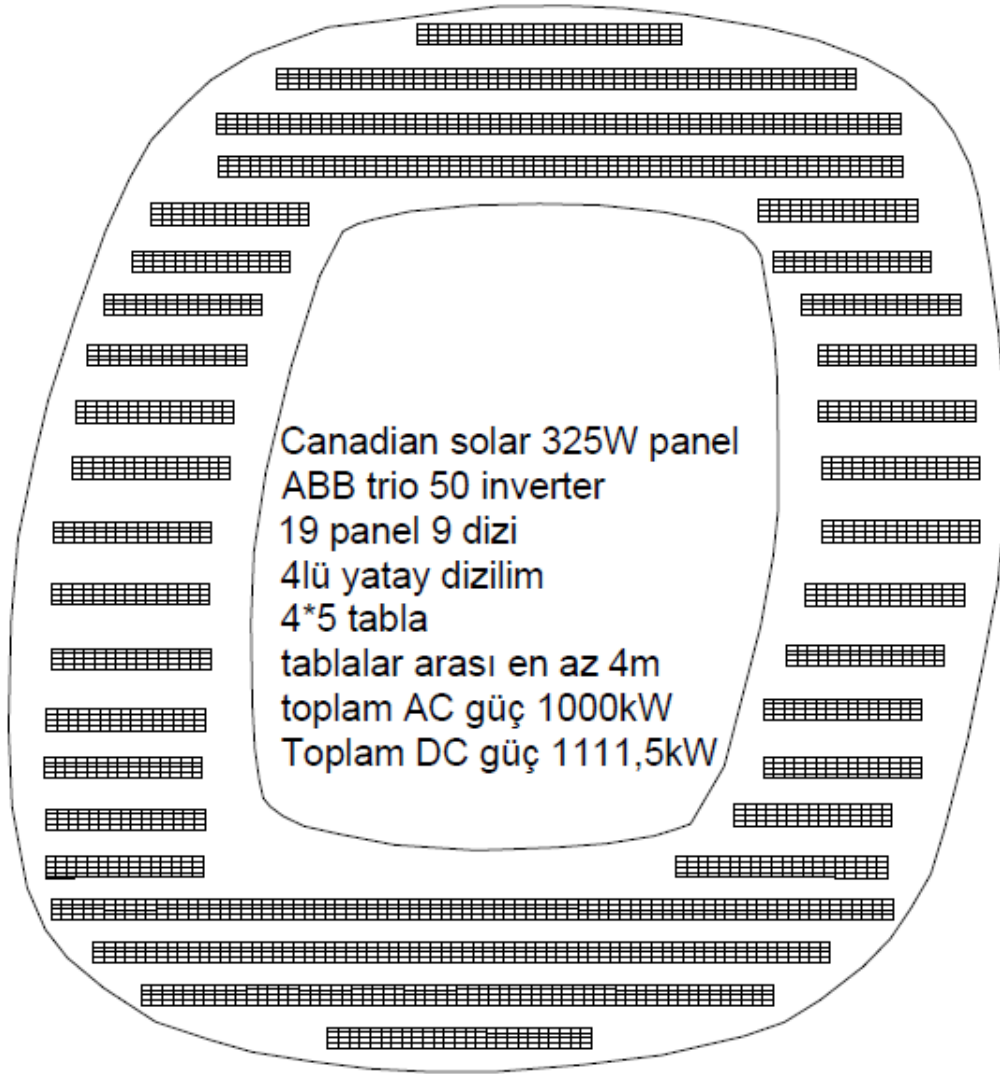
Alanya Stadyumu Genel Yerleşim Planında Bulunan Detay-A
